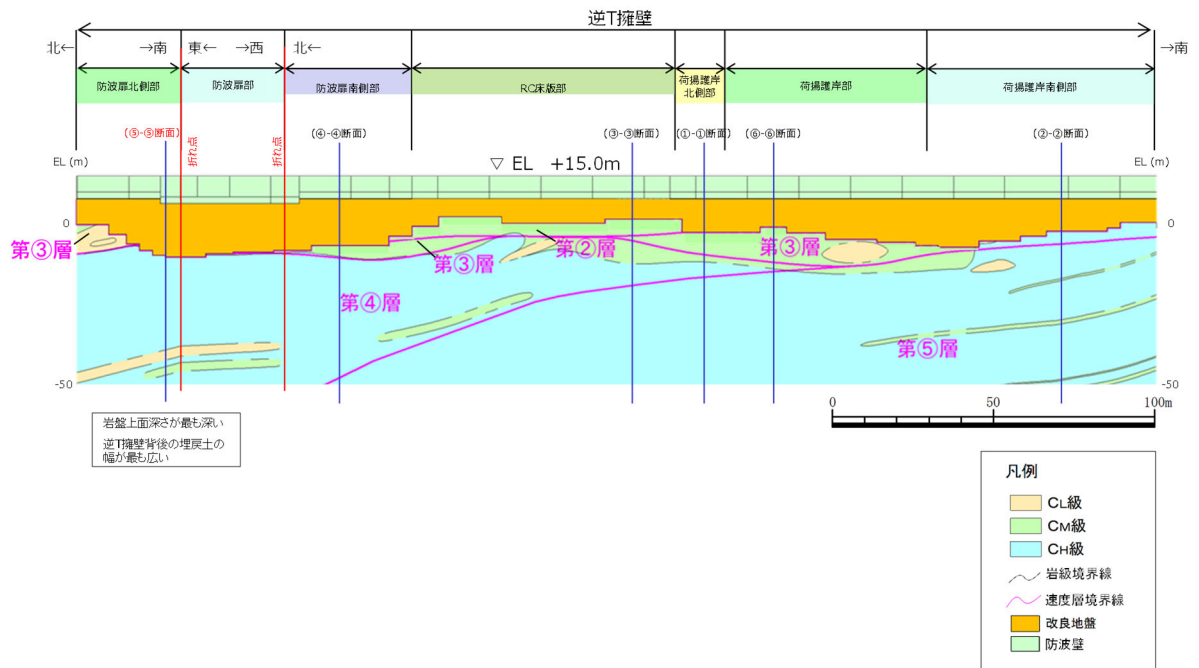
防波壁（逆 T 擁壁）縦断面図
